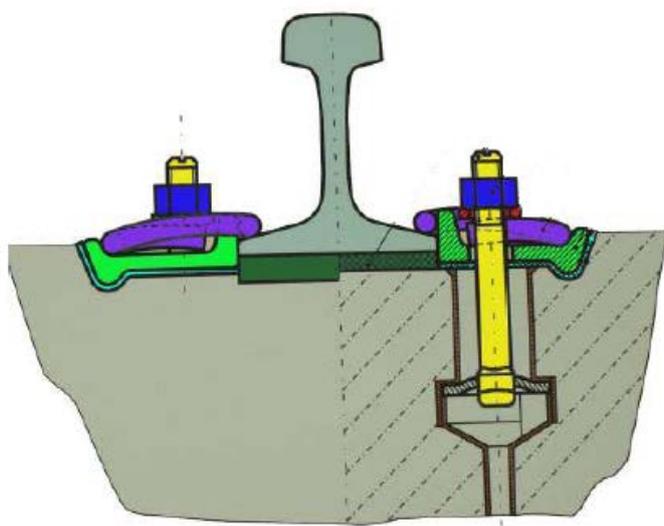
Упругое нераздельное рельсовое крепление с прутковыми торсионными клеммами для железобетонных шпал (подкладка, и клеммы крепятся к шпале при помощи анкерных болтов)
